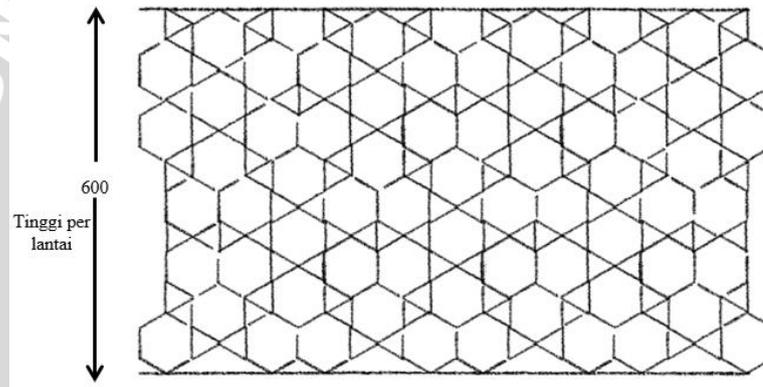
Alternatif dimensi panel 1 (50cm)
